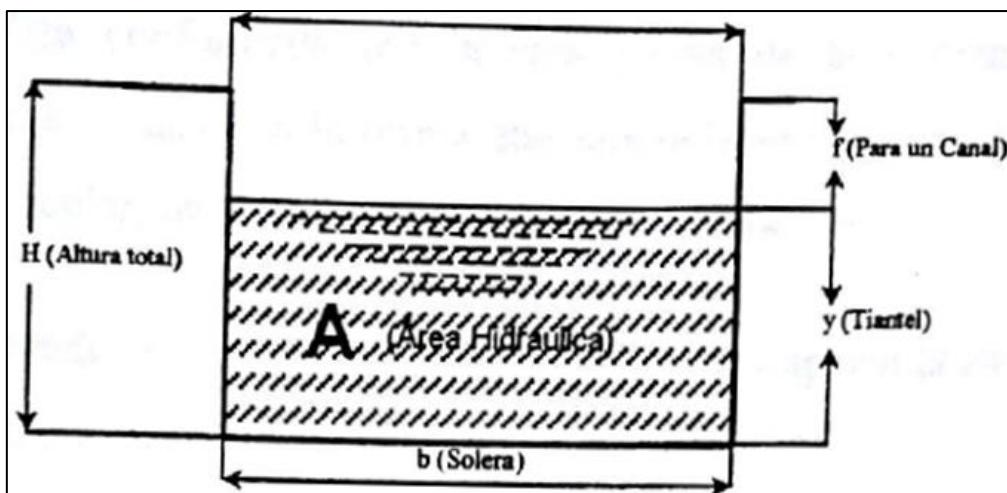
Sección rectangular de un canal (Fuente: Walter Morales Uchofen, “Infraestructura de Riego”)
